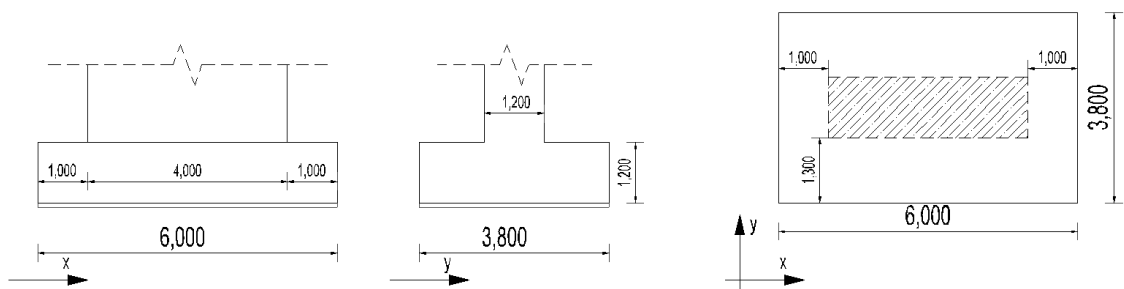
Dimensões e geometria da sapata do encontro E1
